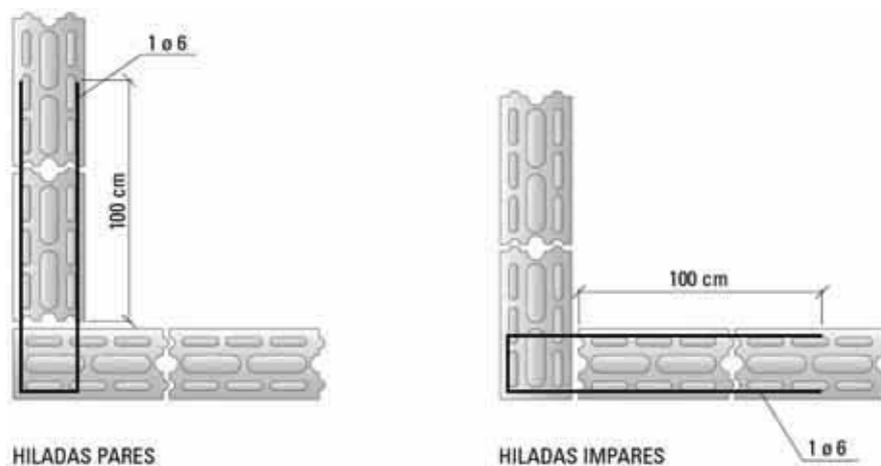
Refuerzo de esquinas en muros de fábrica no armada de bloques de árido ligero.
